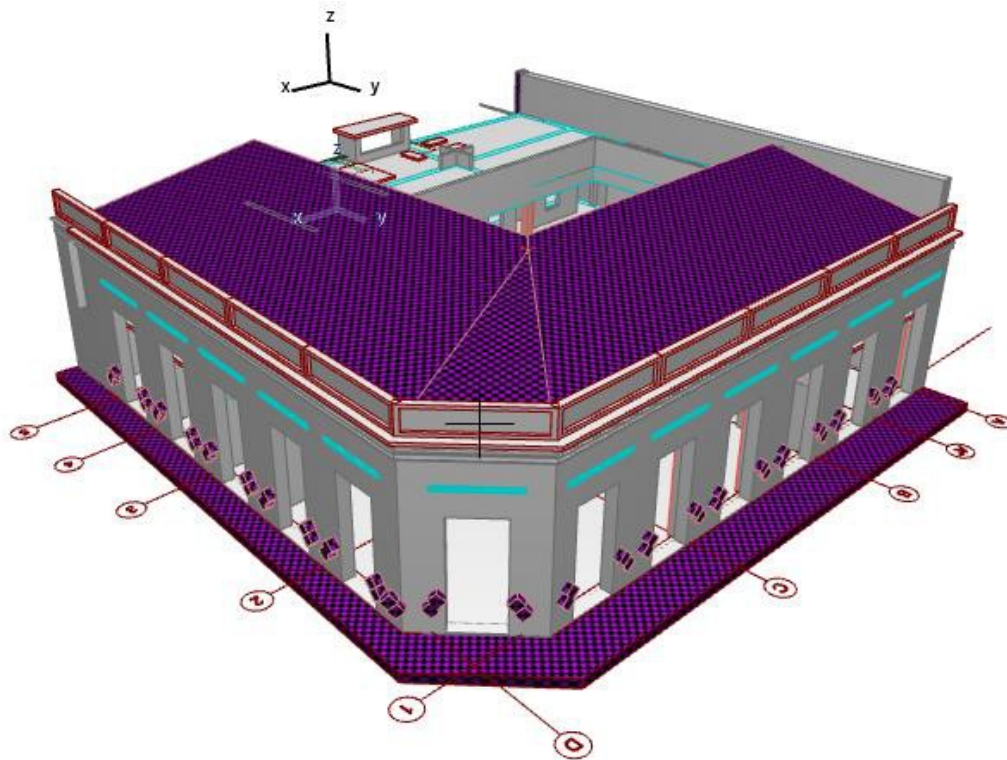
Vista del modelo arquitectónico en ArchiCAD®.
